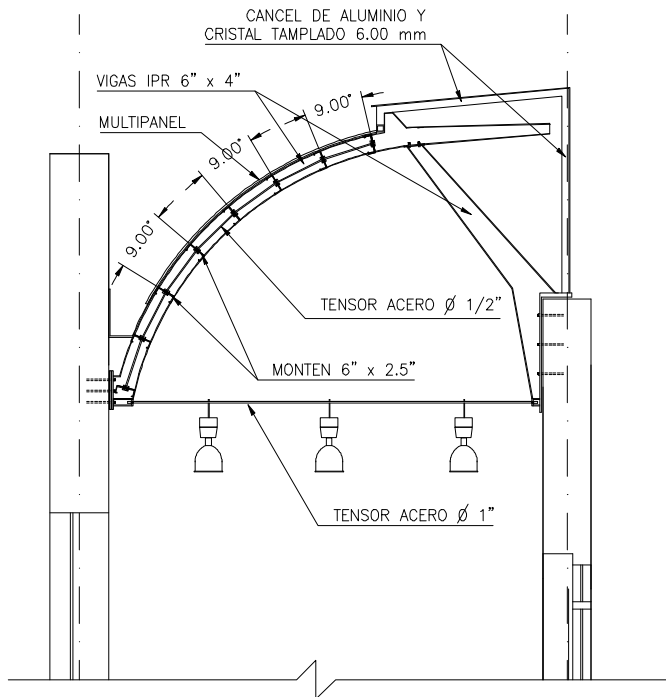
SISTEMA CONSTRUCTIVO PARA TECHUMBRE EN AULAS
